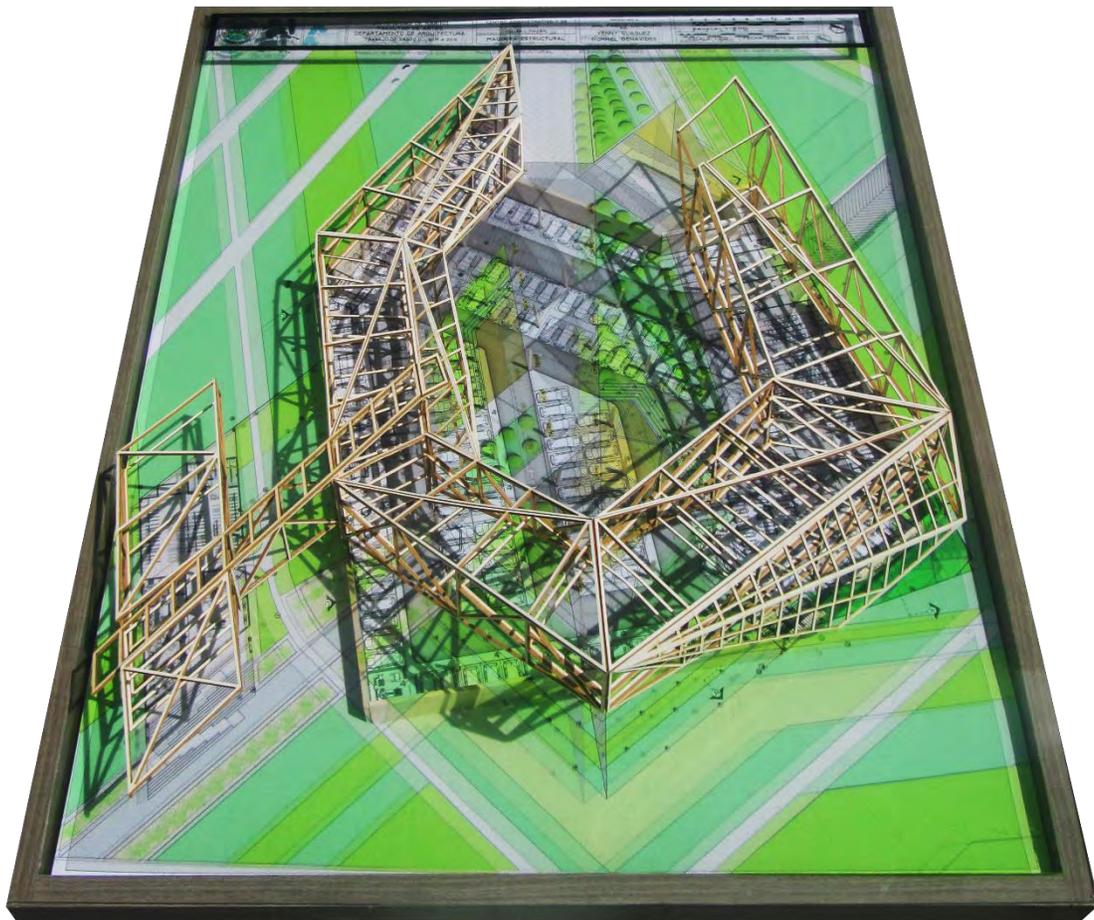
Fotografía de maqueta estructural vista norte. Fuente: Elaboración propia
